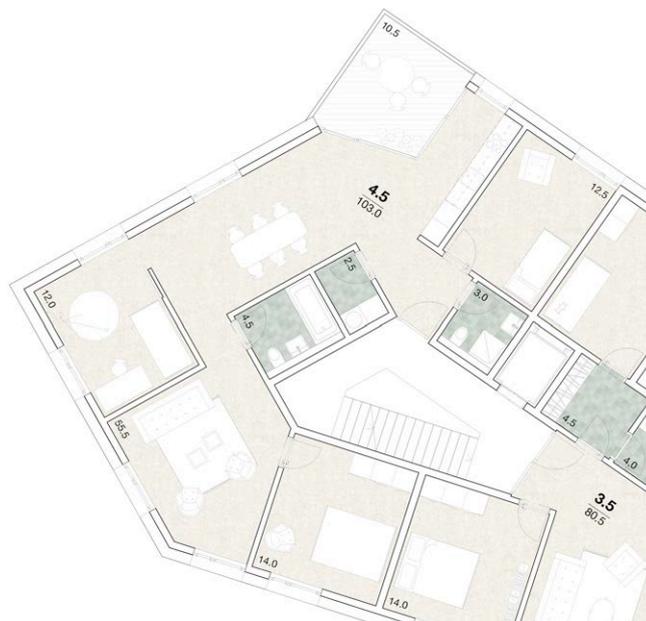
Grundriss 4.5 Zimmer Wohnung
